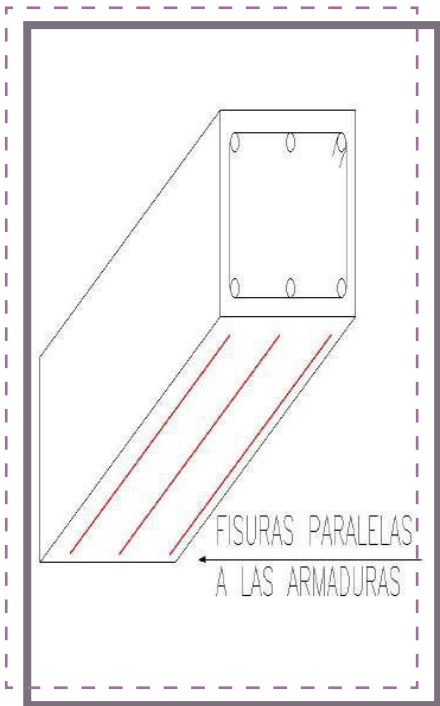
Esquema de las fisuras en viga de hormigón armado por corrosión de armaduras.
